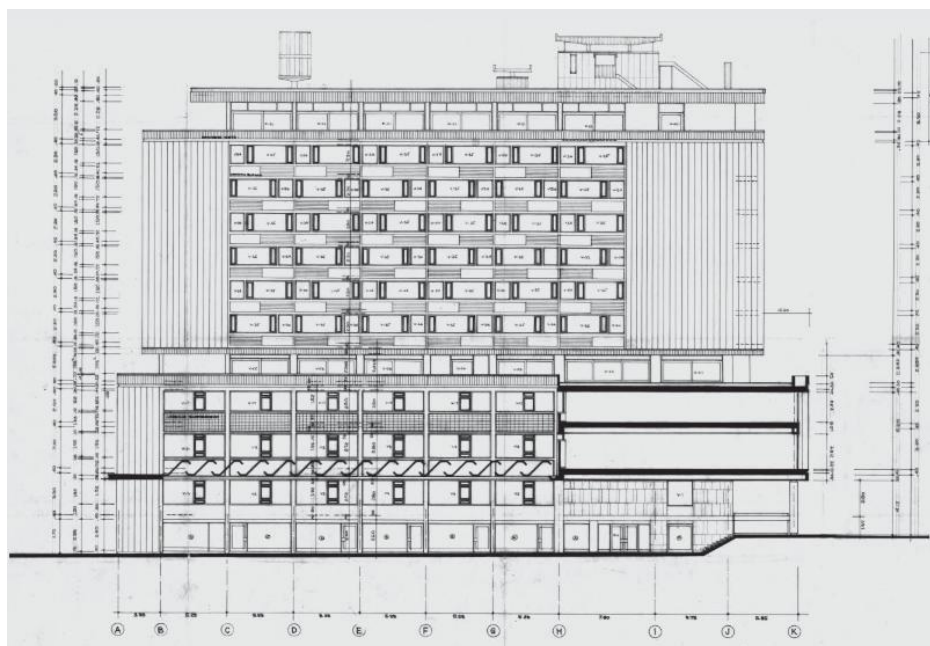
Cortes Fachada. Banco de Comercio. Planoteca O&V. Archivo Distrital de Bogotá
